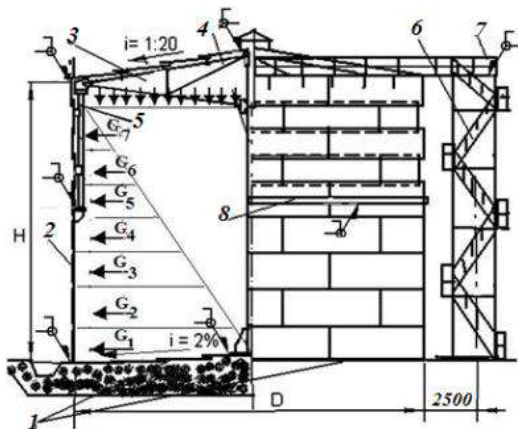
Общий вид вертикального цилиндрического сварного резервуара
